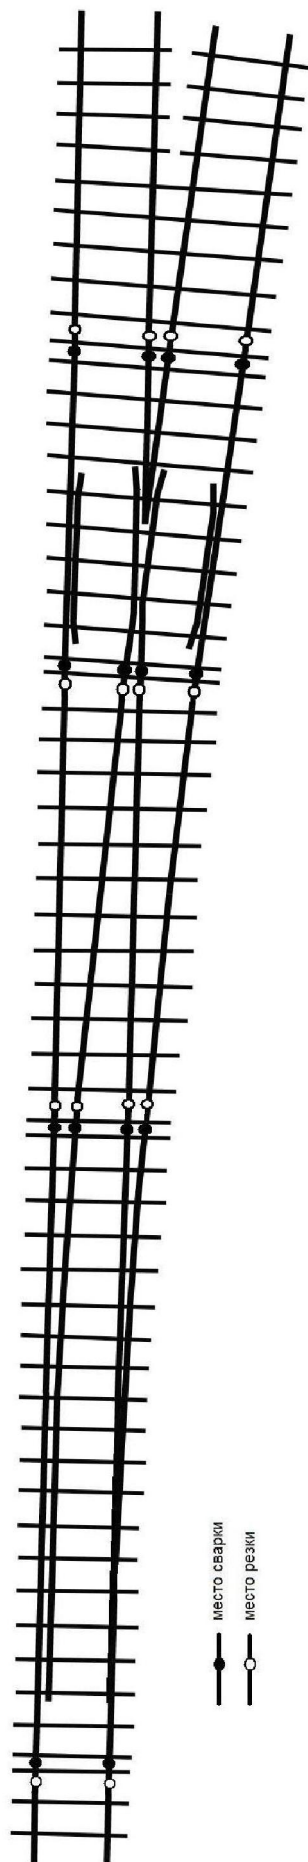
Места сварки и резки рельсов в пересечениях.
